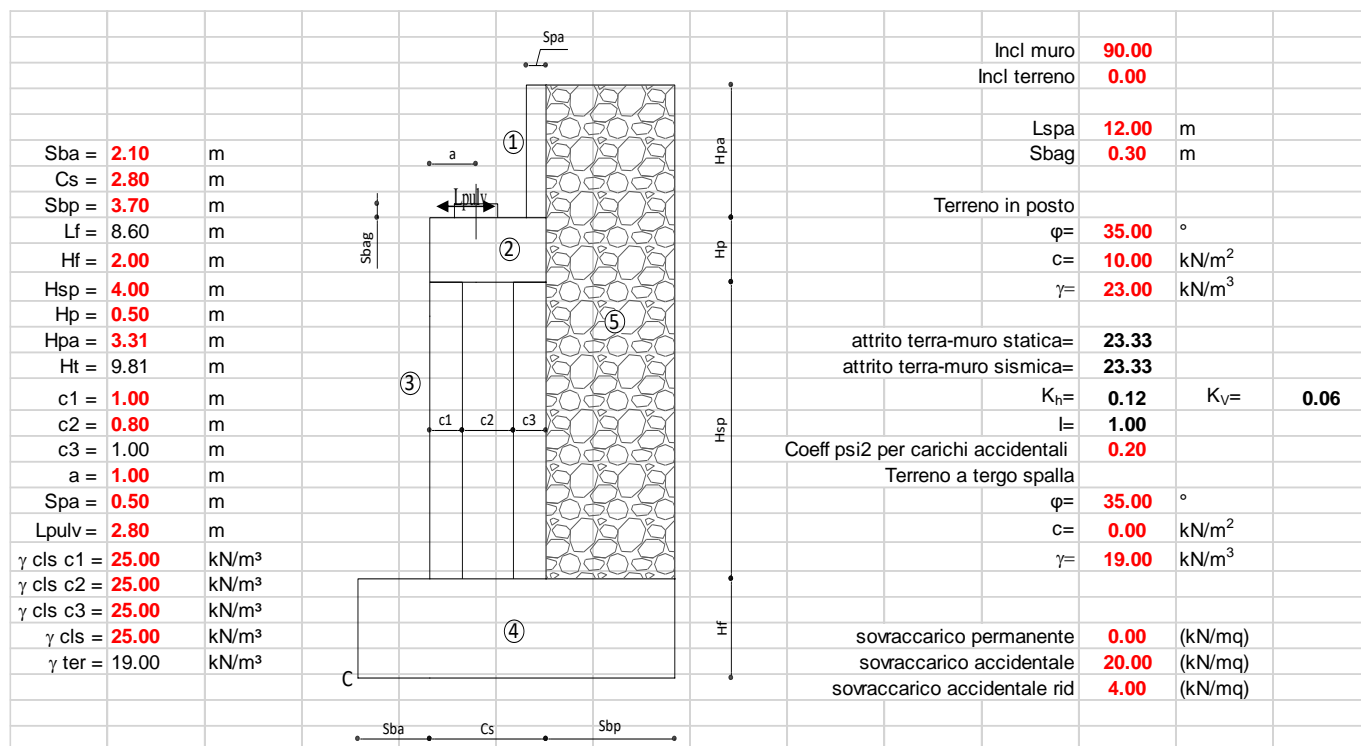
Caratteristiche geometriche spalla B
